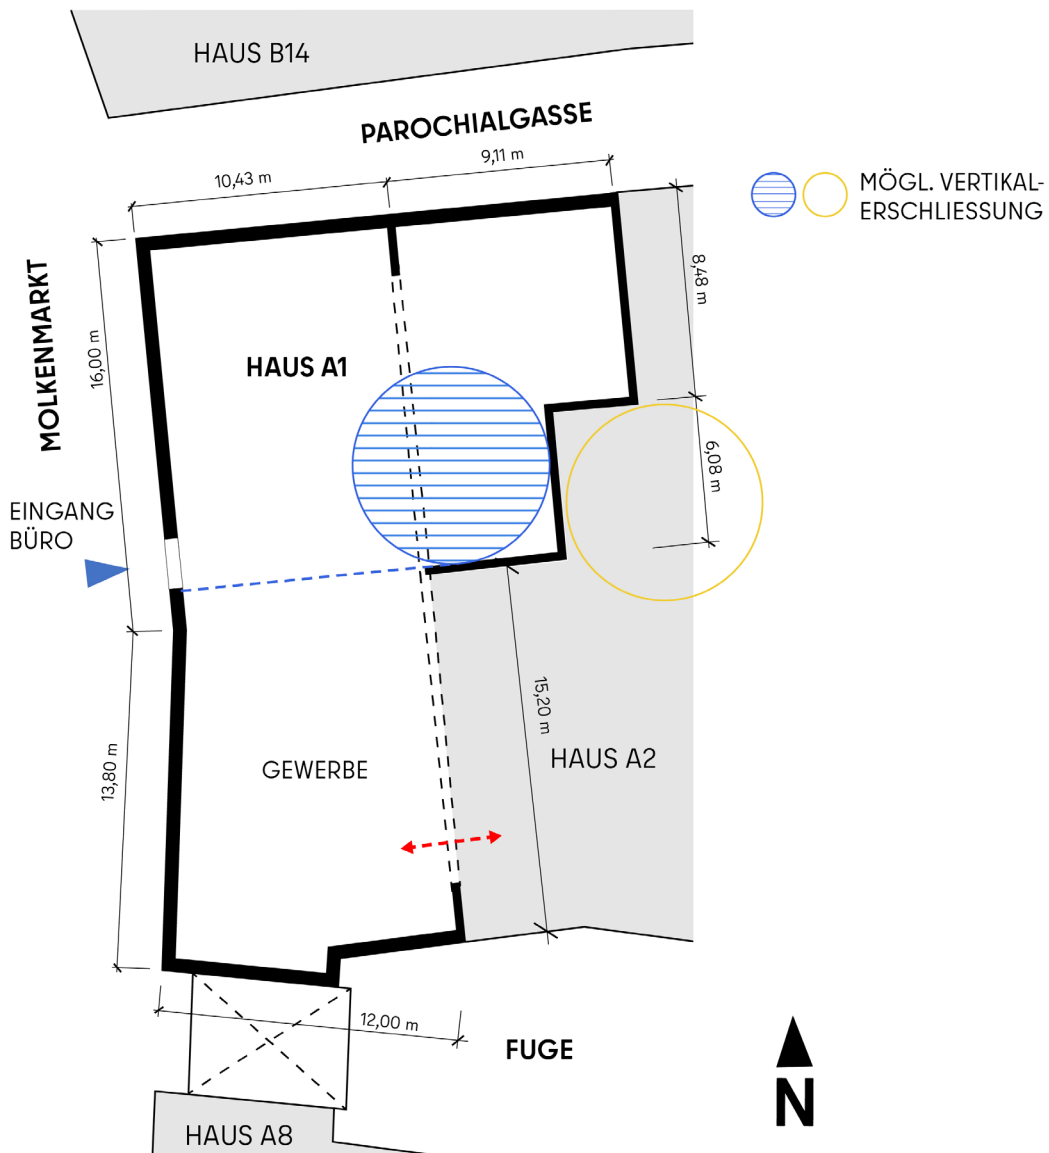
Schematischer Grundriss Erdgeschoss
